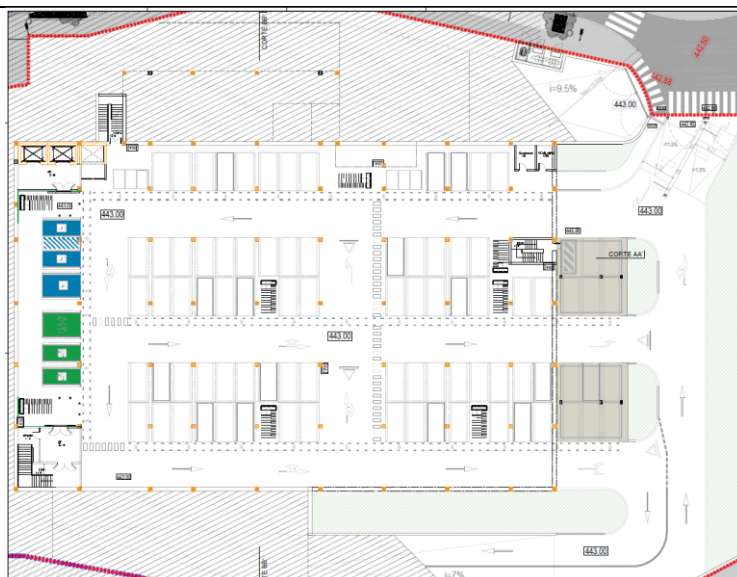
Layout* do piso -1 da Loja Mercadona (estacionamento) (Fonte: EIA – Anexo II, junho 2023)
